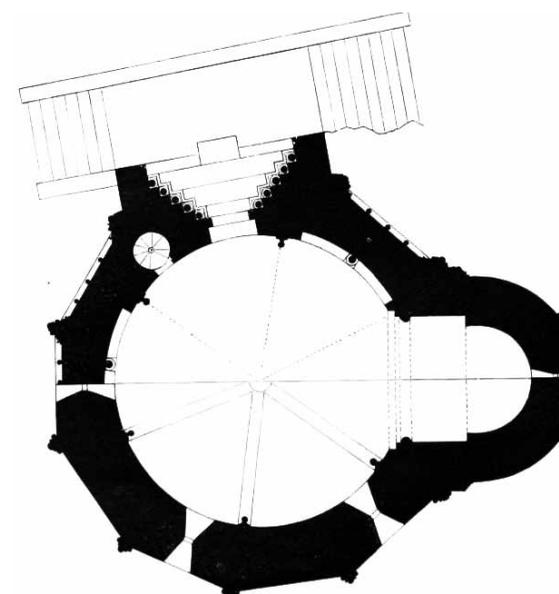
Grundriss Tulln, M 1:200. MdkkCC 1886, 161.
